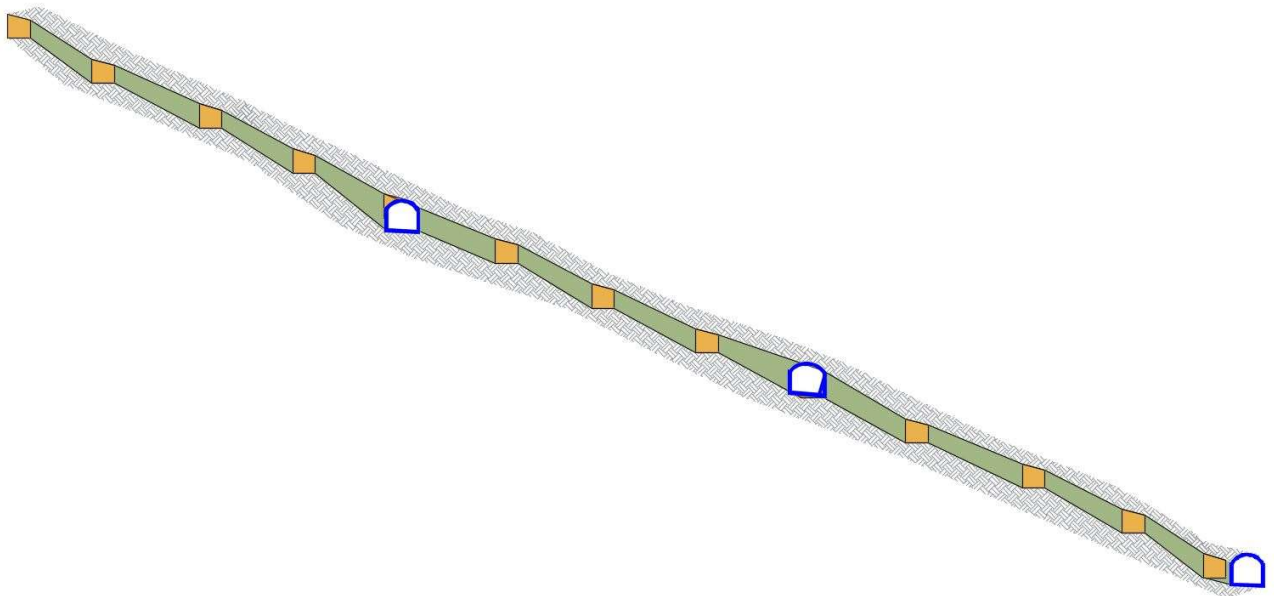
Sezione longitudinale del giacimento intersecato dalla rampa d'accesso e dalle gallerie di tracciamento
